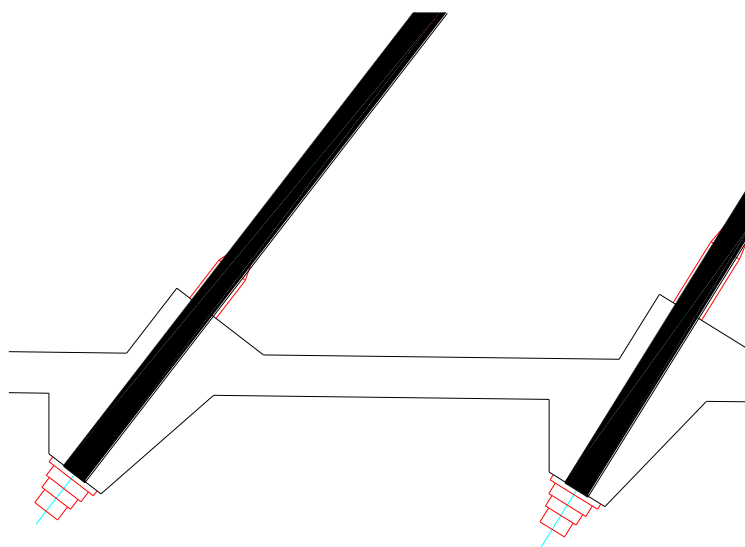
Pormenor das ancoragens inferiores – ligações atirantadas
